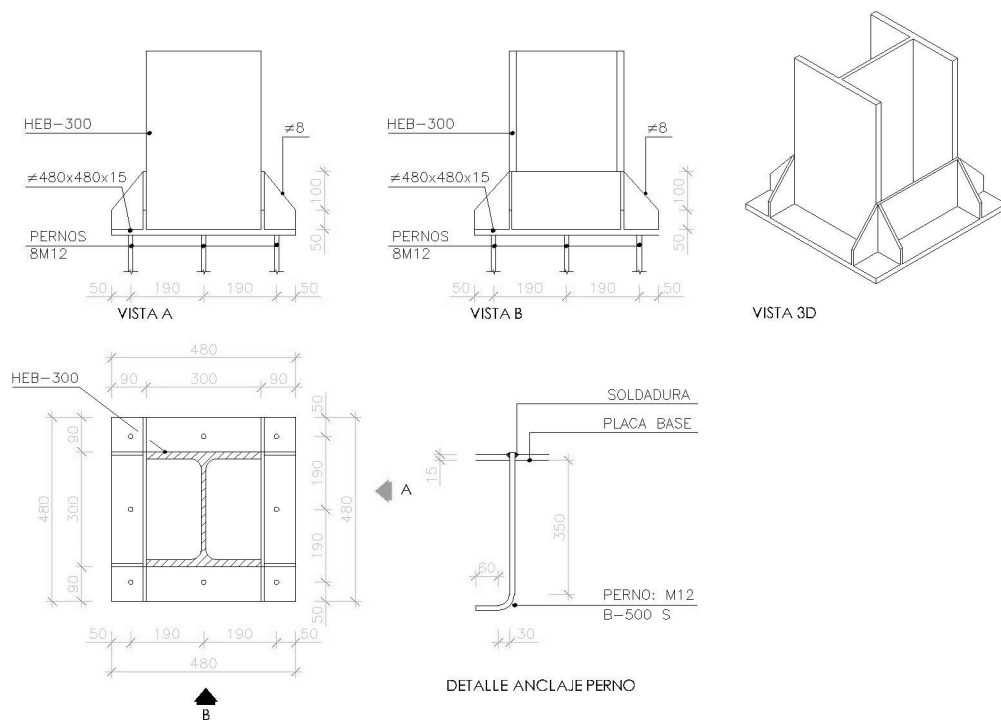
Detalle de las placas de anclaje proyectadas para las bases de los pilares.
